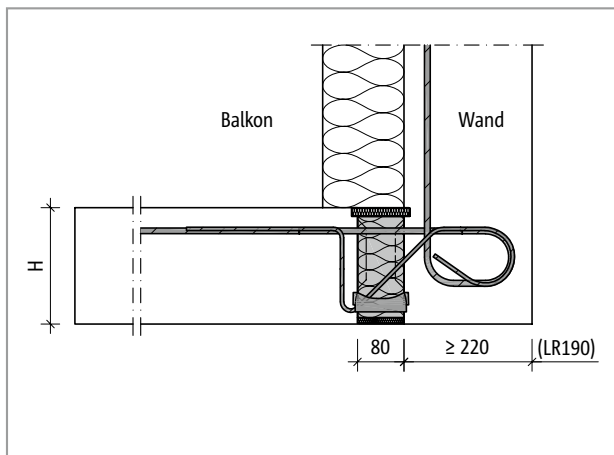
Schöck Isokorb® T Typ K-WO: Wandanschluss nach oben bei Außendämmung
